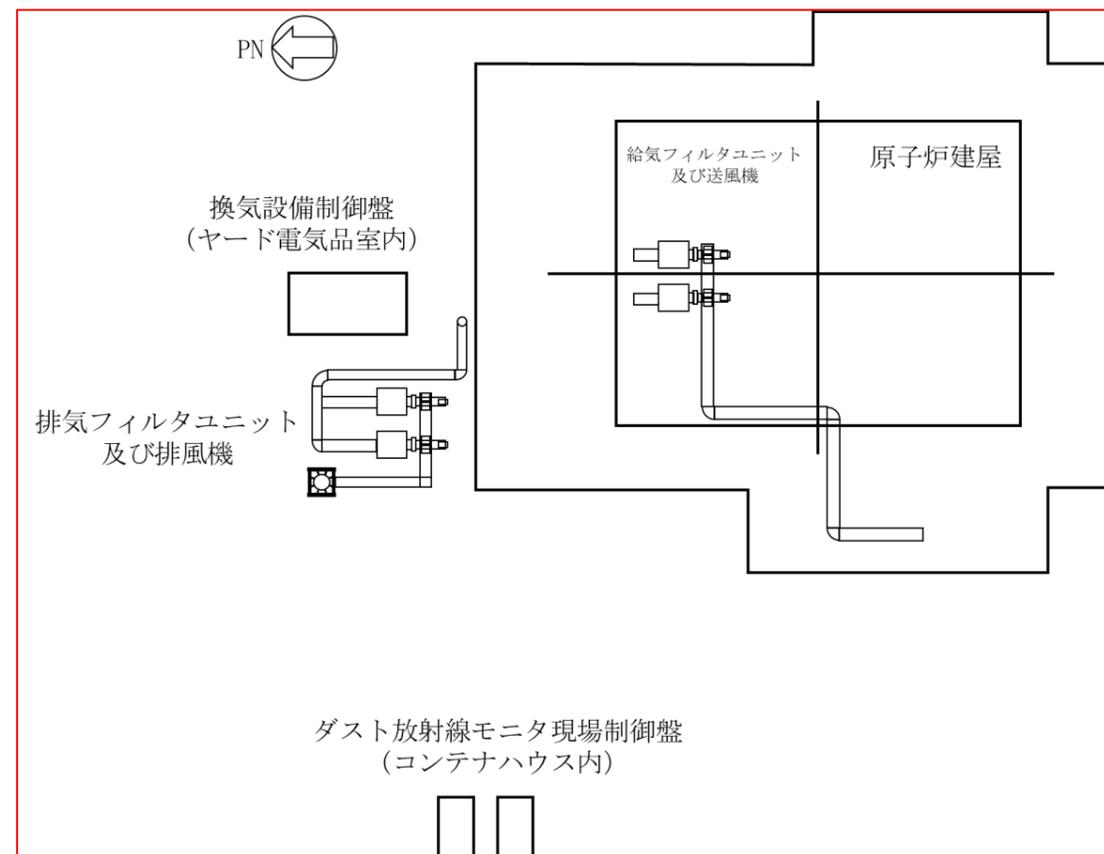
大型カバー換気設備 (燃料取り出し作業時) 配置図
